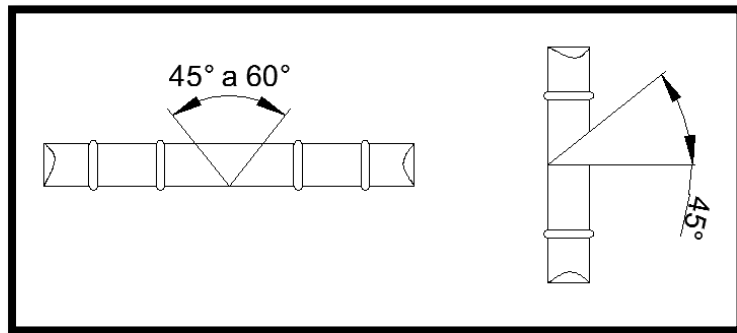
Ángulos de bisel para realizar soldadura en acero de refuerzo
